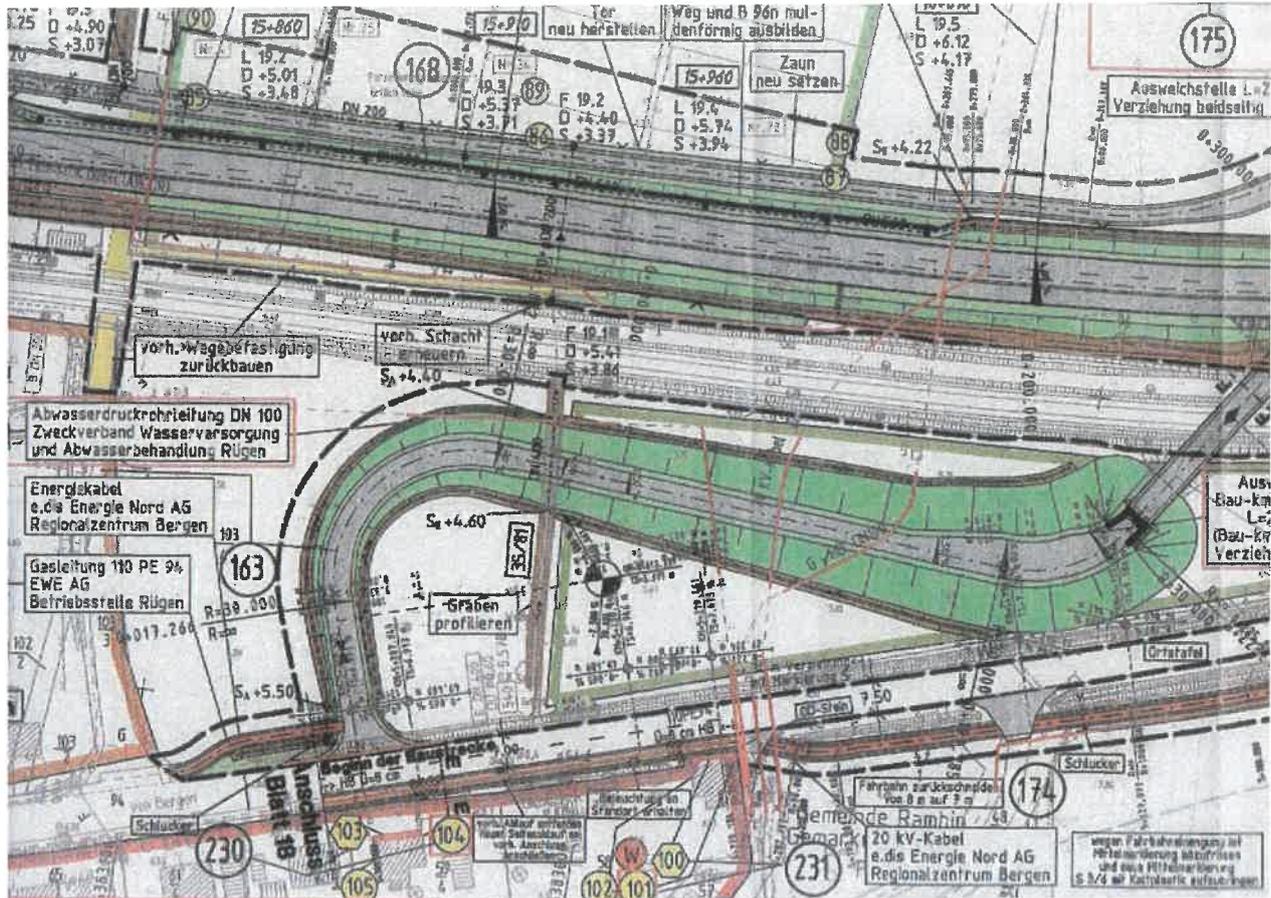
Planfeststellungsbeschluss B96n; Neubau Gemeindestraße nach Kasselwitz
